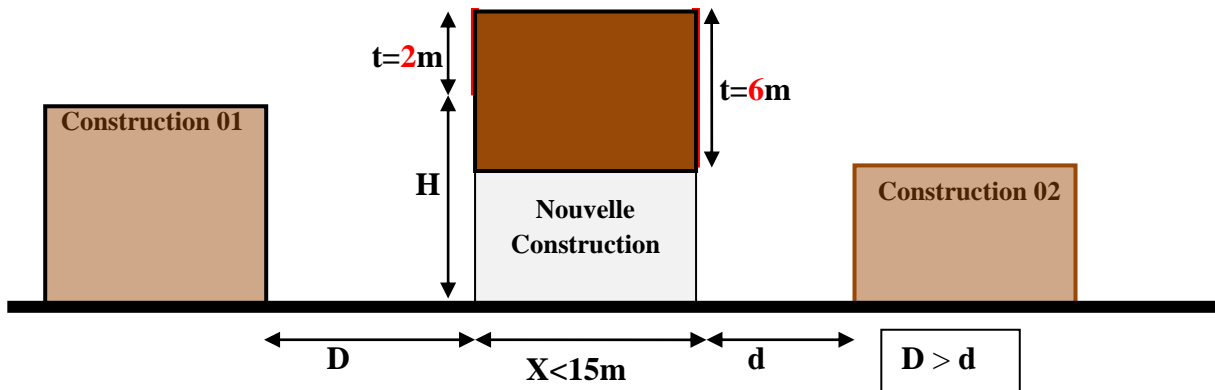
Coupe définissant la hauteur d'une construction localisée entre 2 voies d'inégales largeurs (voies au même niveau).
